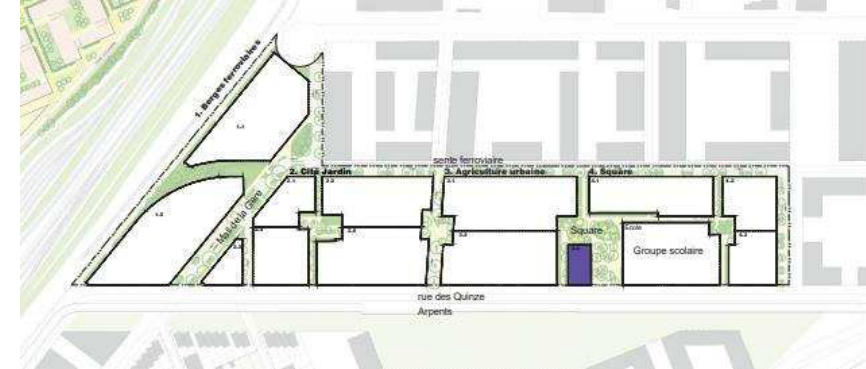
Plan de localisation du lot 4.4 (Source : fiche de lot)
